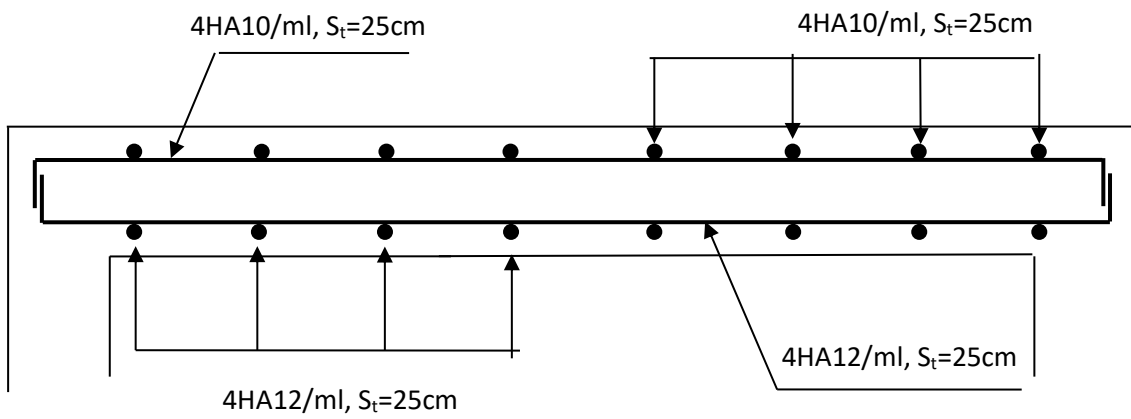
Plan de ferrailage de la salle machine suivant y-y.
